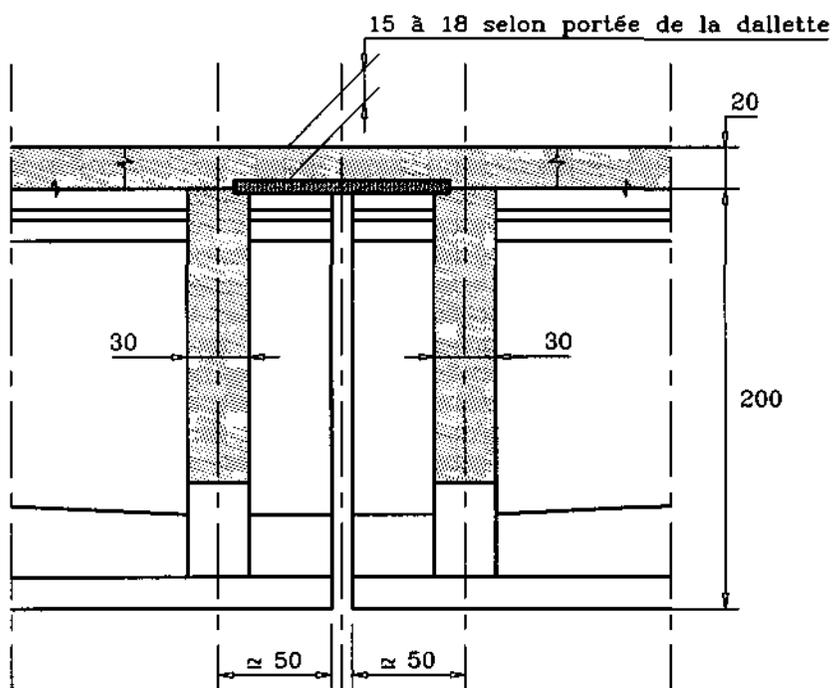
Principe de continuité apparente par dalle de continuité (cotes indicatives)
